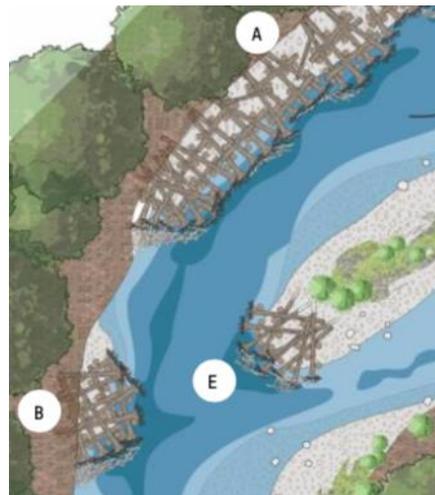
Deux ELJ construits comme ouvrage longitudinal (A) et comme épi (B), en vue schématique. L'élément E n'est pas un ouvrage de protection (source : Planungshilfe ELJ, Renaturierungsfonds, 2019).
